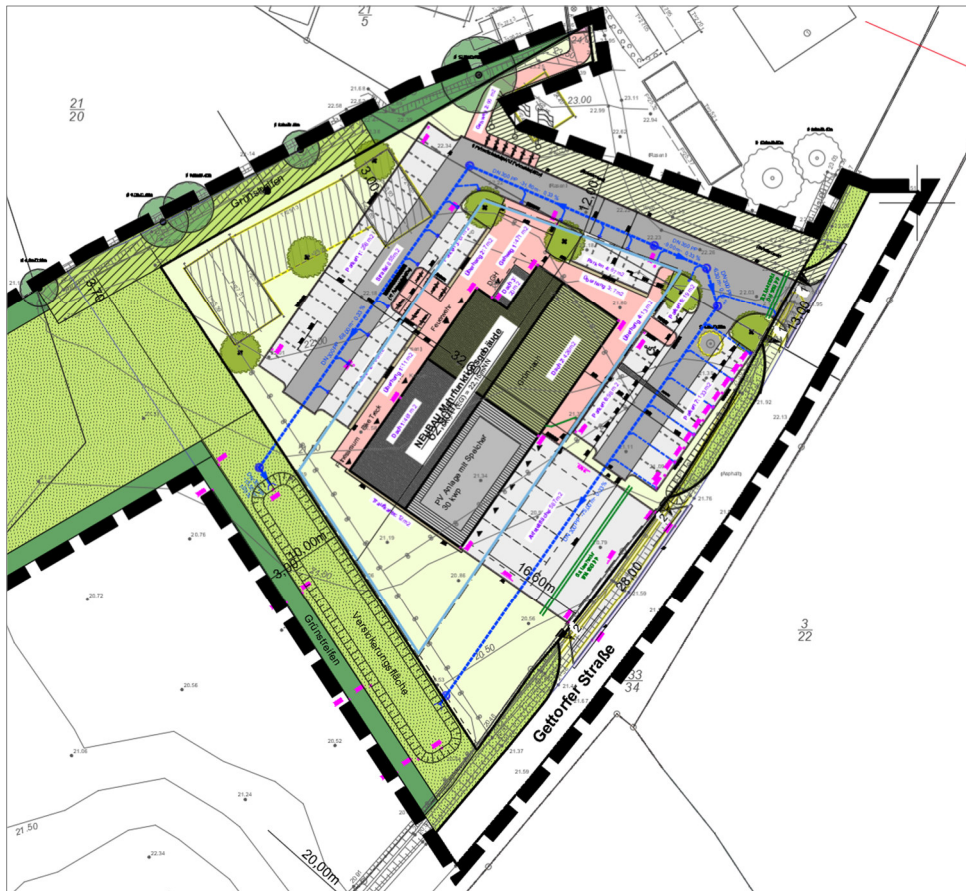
Lageplan Neubau Mehrfunktionsgebäude - Ing.-Büro MEYER, Eck. (siehe auch Anlage 4)
